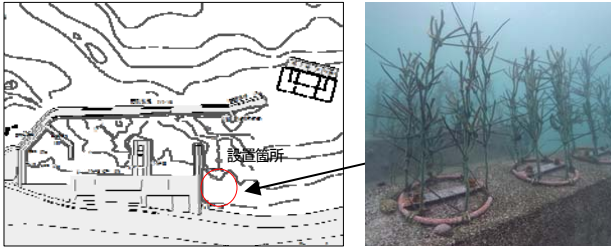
雄冬漁港 設置箇所 (H13型)      写真-9 設置状況
